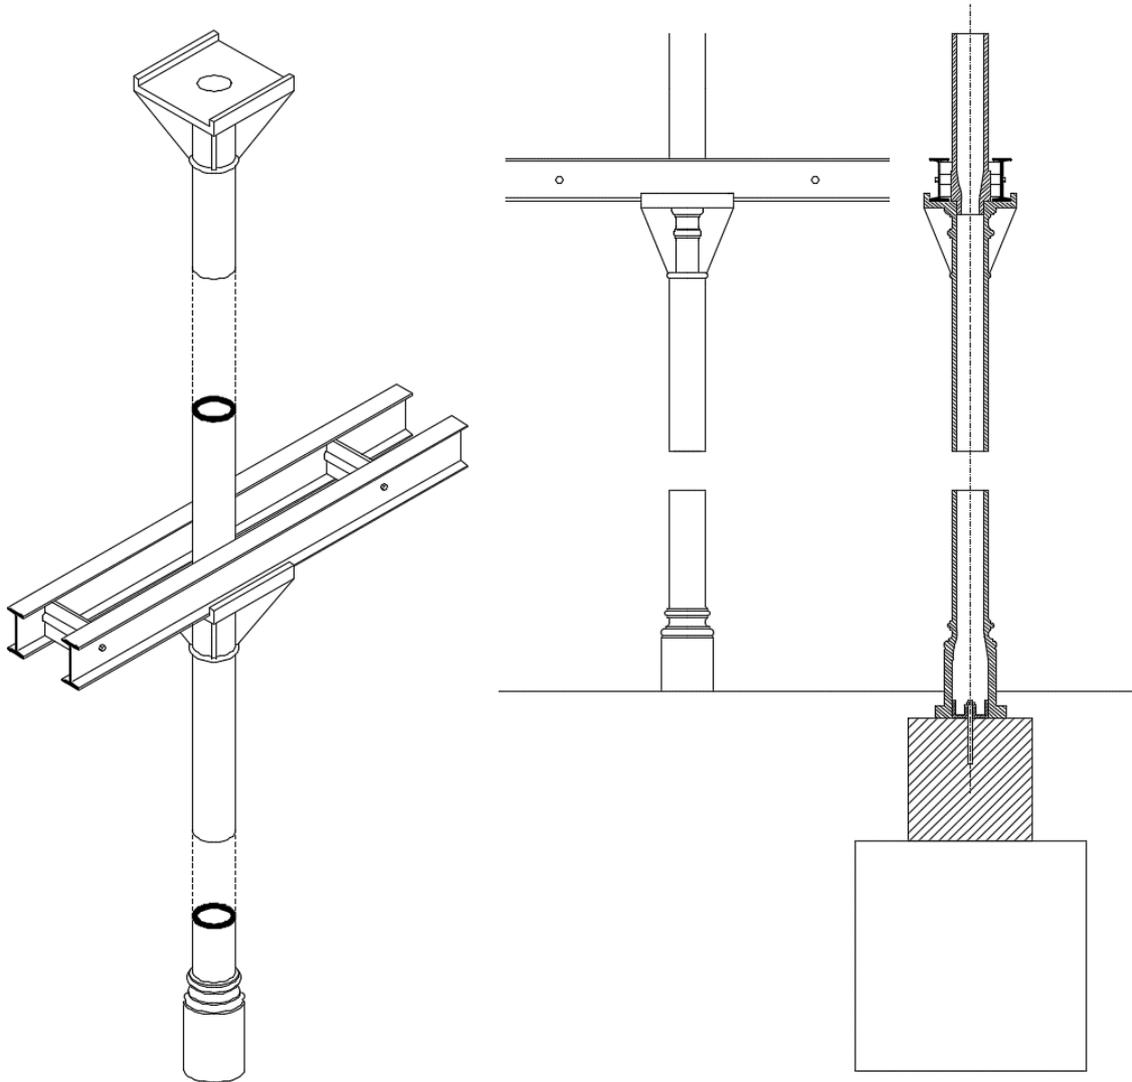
Enlace entre los elementos que forman el pórtico. Columnas y vigas gemelas.
